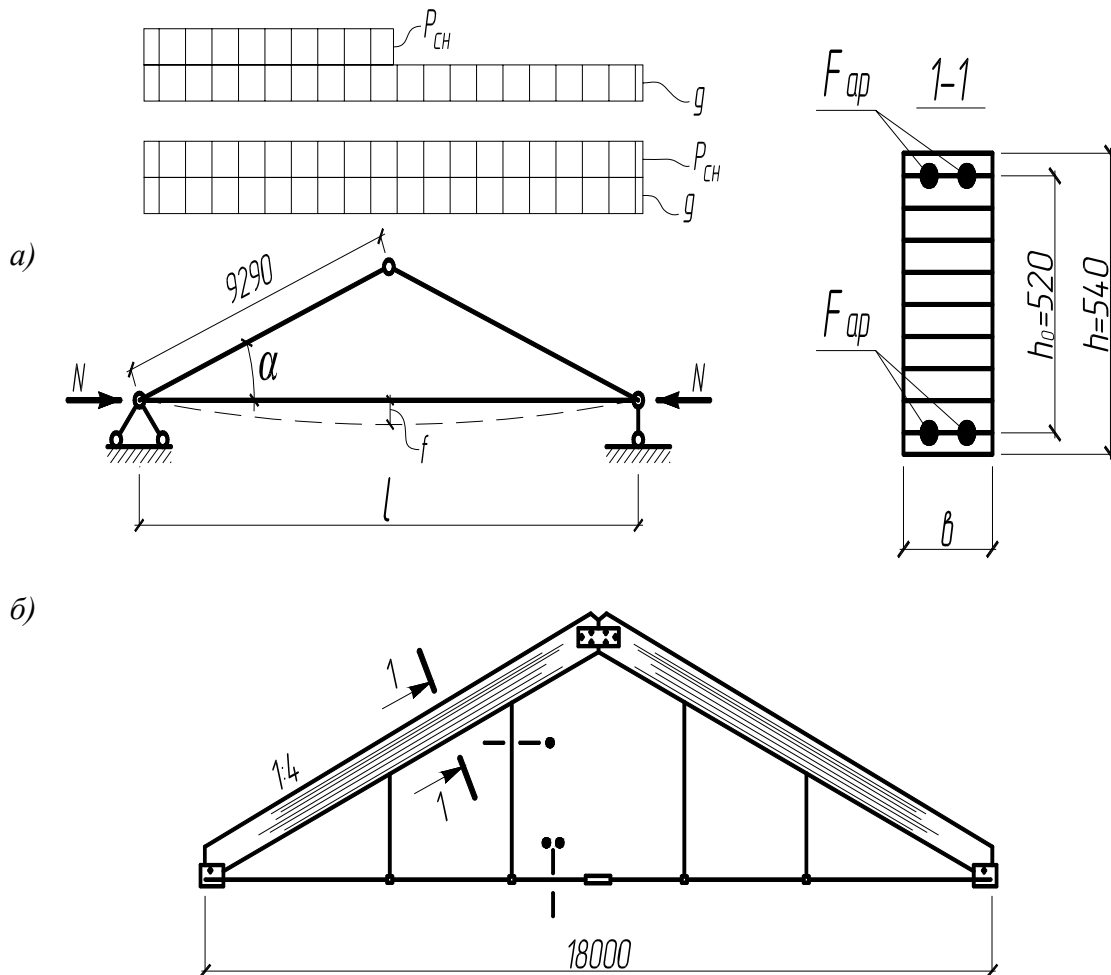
Расчетная схема (а) и общий вид (б) трехшарнирной арки с клееным армированным верхним поясом и стальной затяжкой
